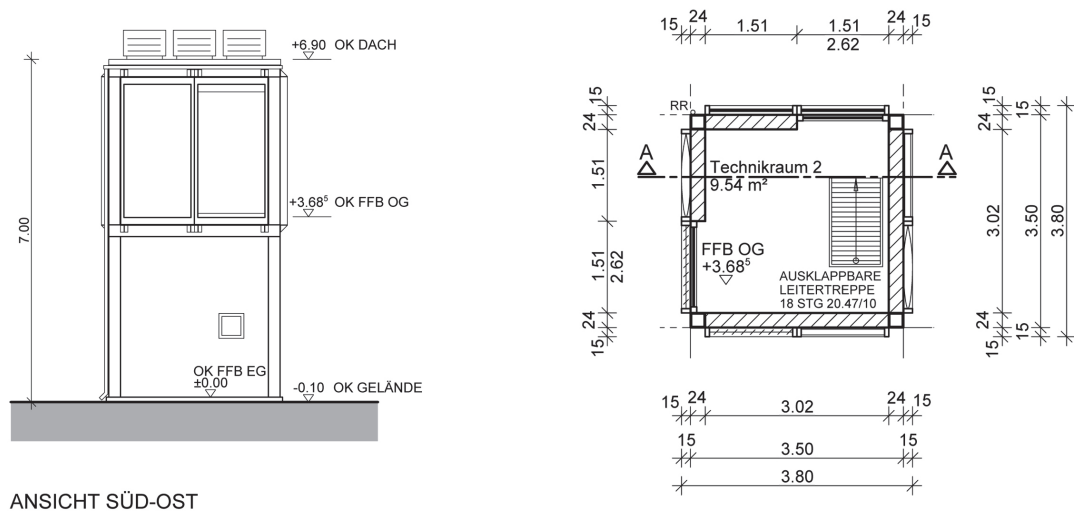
Versuchsbau, Grundriss und Schnitt (Sandra Fuchs, Bauhaus-Universität Weimar, FOGEB)
